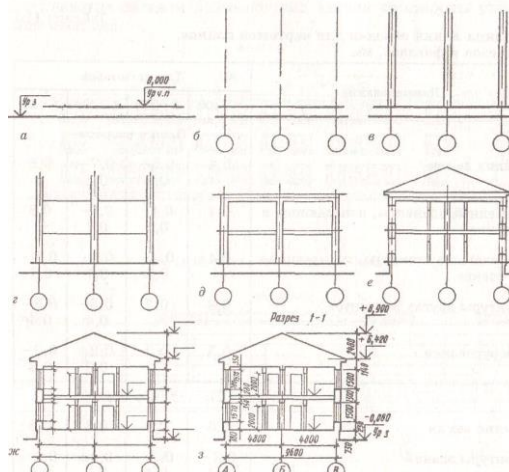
Пример выполнения поперечного архитектурного разреза гражданского здания с несущими продольными стенами
